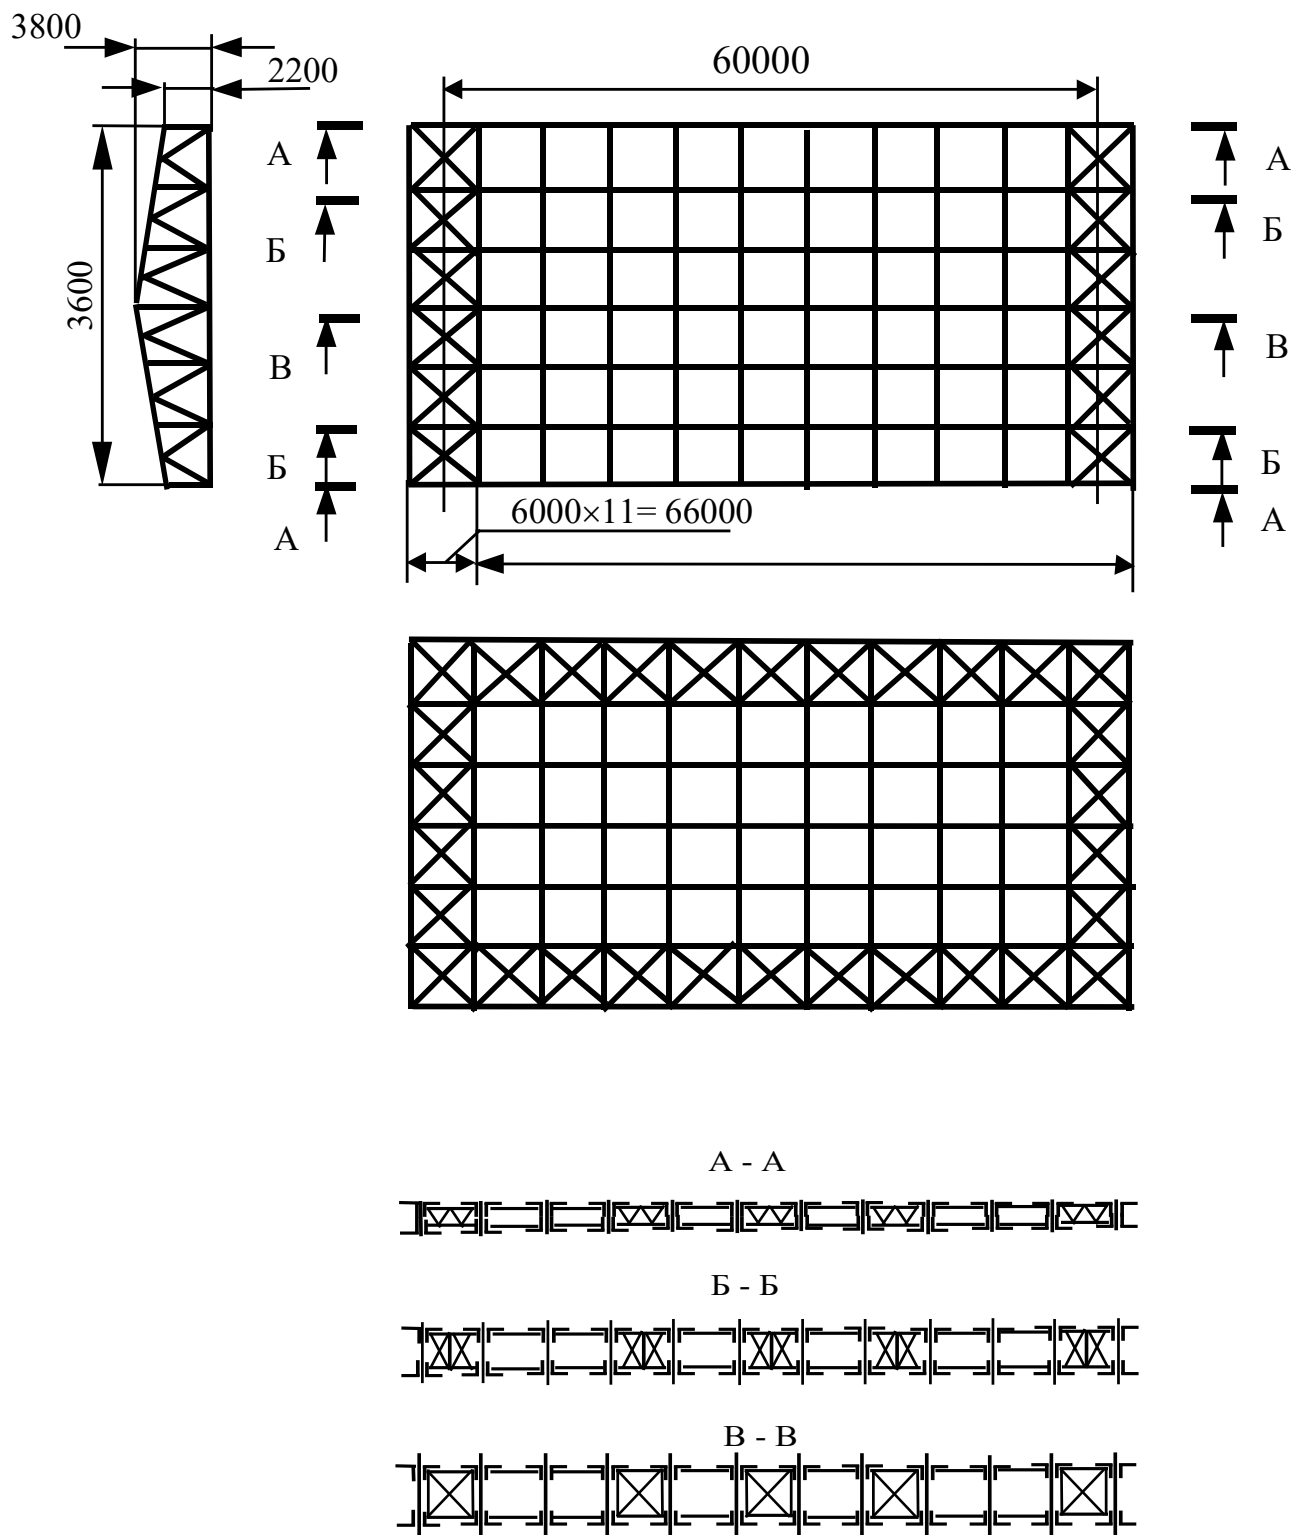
Пример расстановки связей в перекрытии тяжёлого цеха
